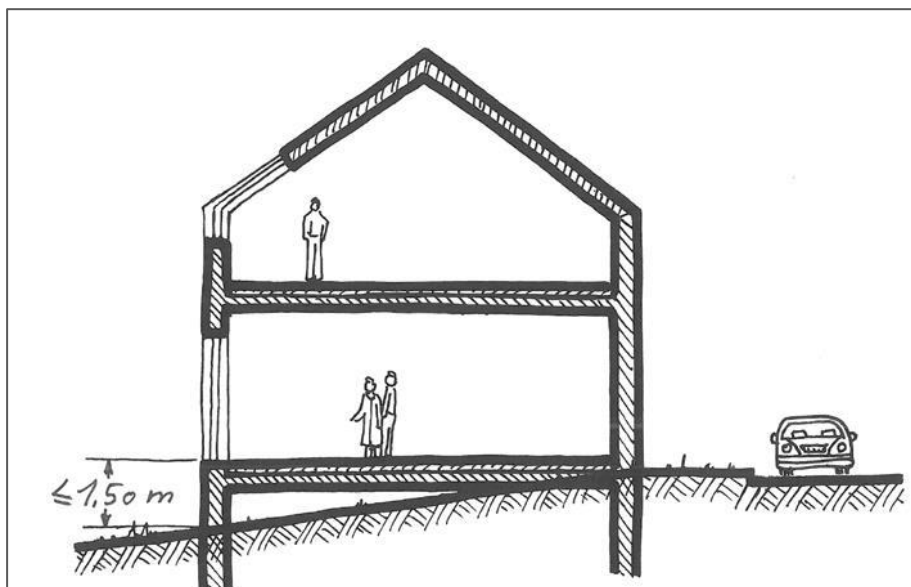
différence de hauteur entre le terrain naturel et le rez-de-chaussée ou le rez-de-jardin
